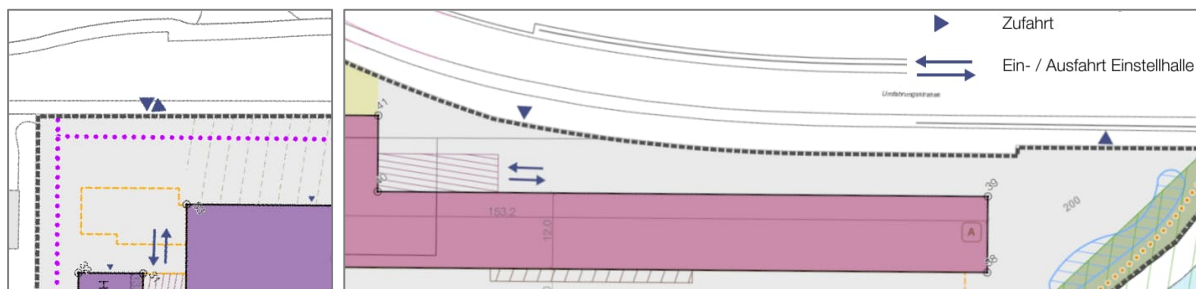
Areal-Zufahrten Ettiswilerstrasse (links) und Umfahrungsstrasse (rechts); Ein-/Ausfahrten Einstellhalle
